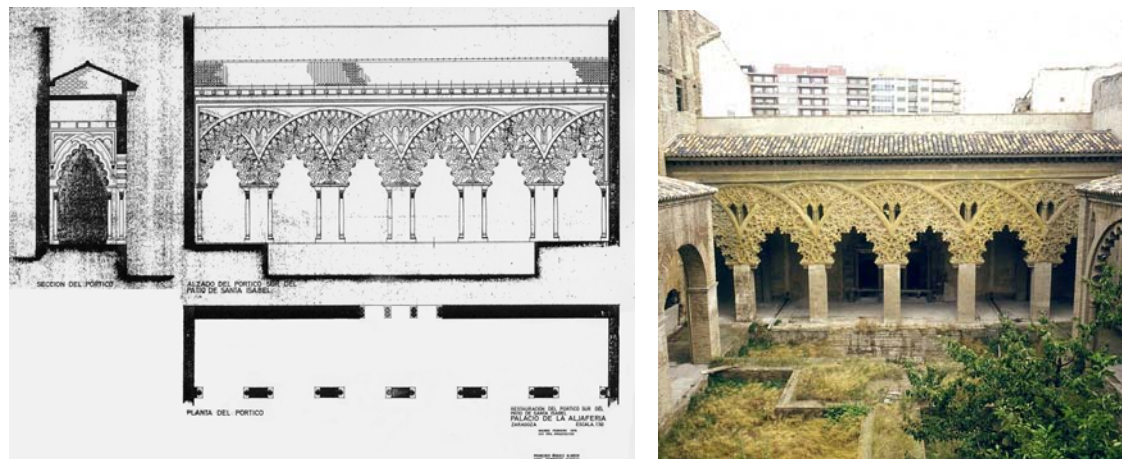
Planimetría existente (invertida) referente a la reconstrucción del pórtico Sur del patio (F. Iñiguez y A. Peropadre) y fotografía real del mismo
